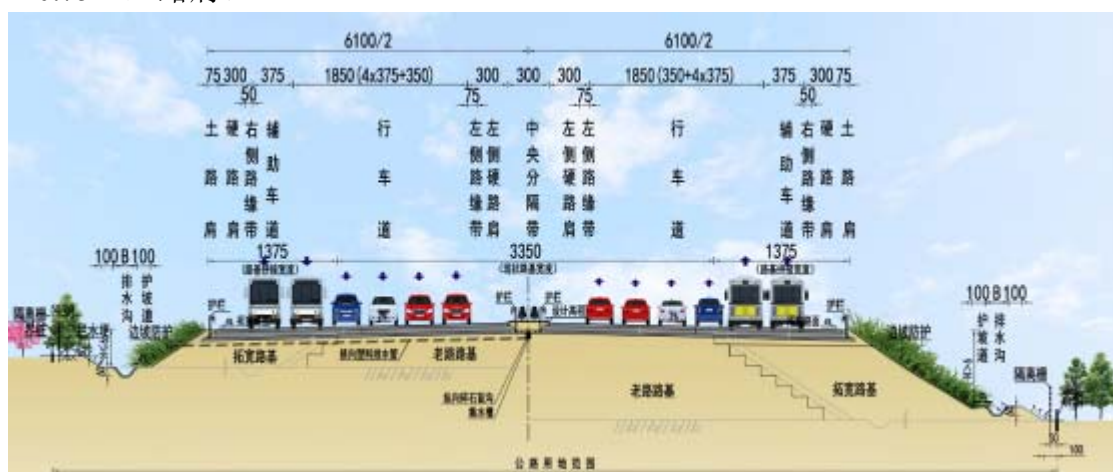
(2) 主线增设辅助车道路段路基标准横断面图
